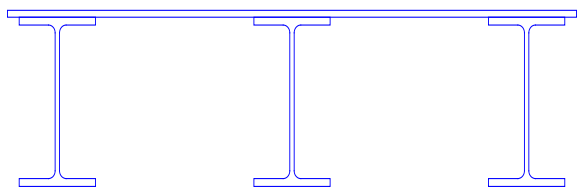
Ортотропная конструкция с открытыми ребрами. Без нагрузки
